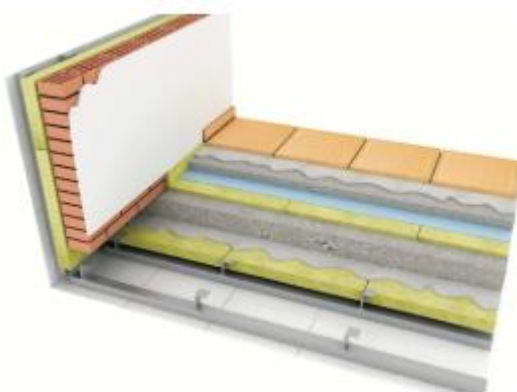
a) – Isolamento de lâ de rocha sobre a laje [19]
